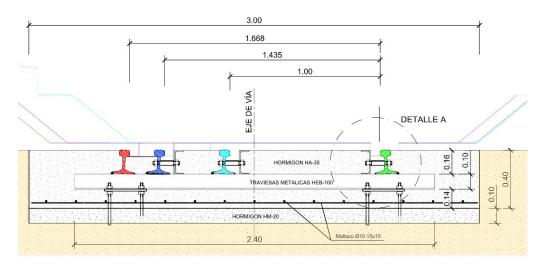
SECCION TIPO TRIPLE ANCHO
